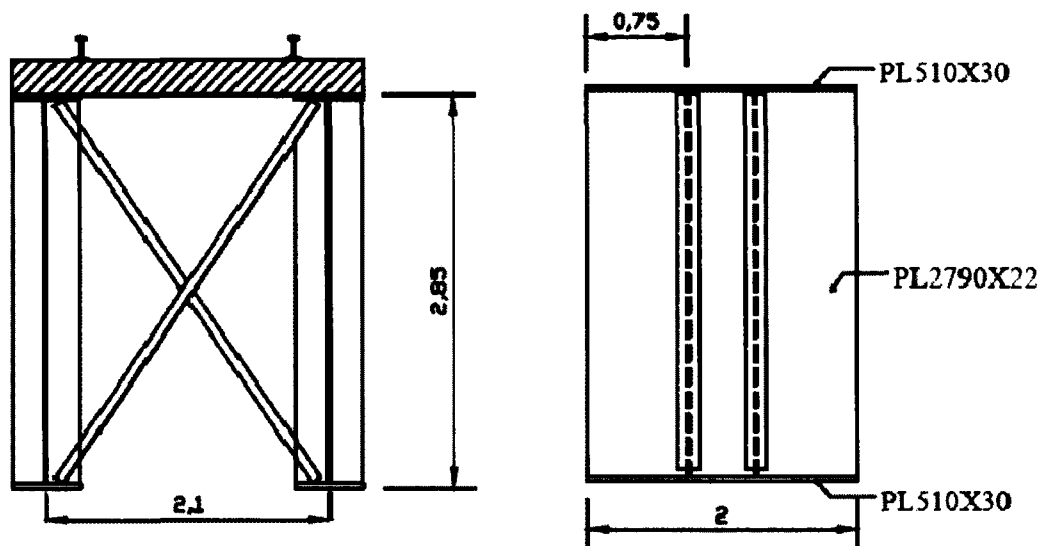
Pont bi-poutres - Section transversale et élévation - Section G-3
